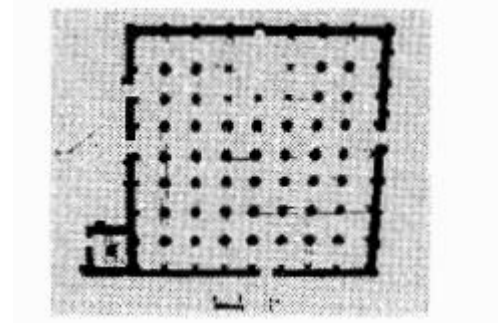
مسقط أفقي لجامع الباشا بوهران عن
